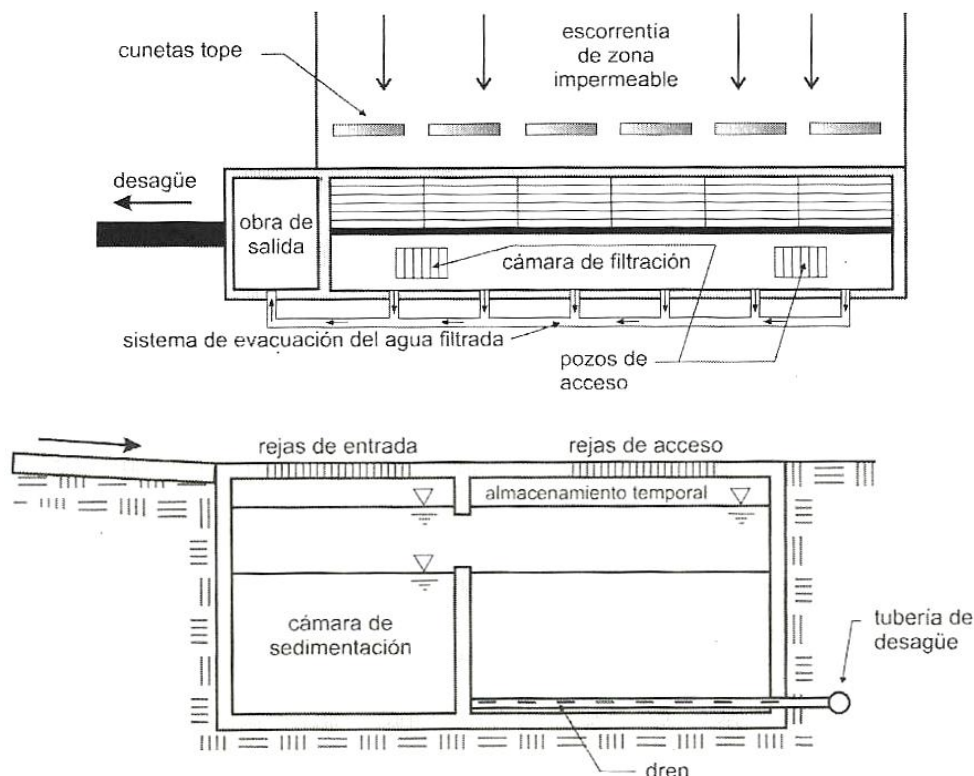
Esquema de la planta y el perfil de un filtro perimetral. Fuente CEDEX (2008).
